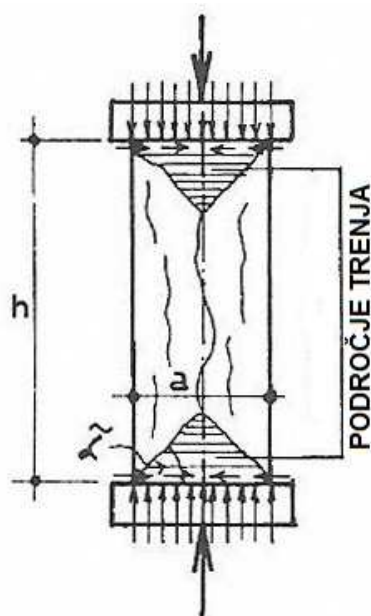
Obnašanje tlačno obremenjenega betonskega elementa (Muravljov, 2007)
